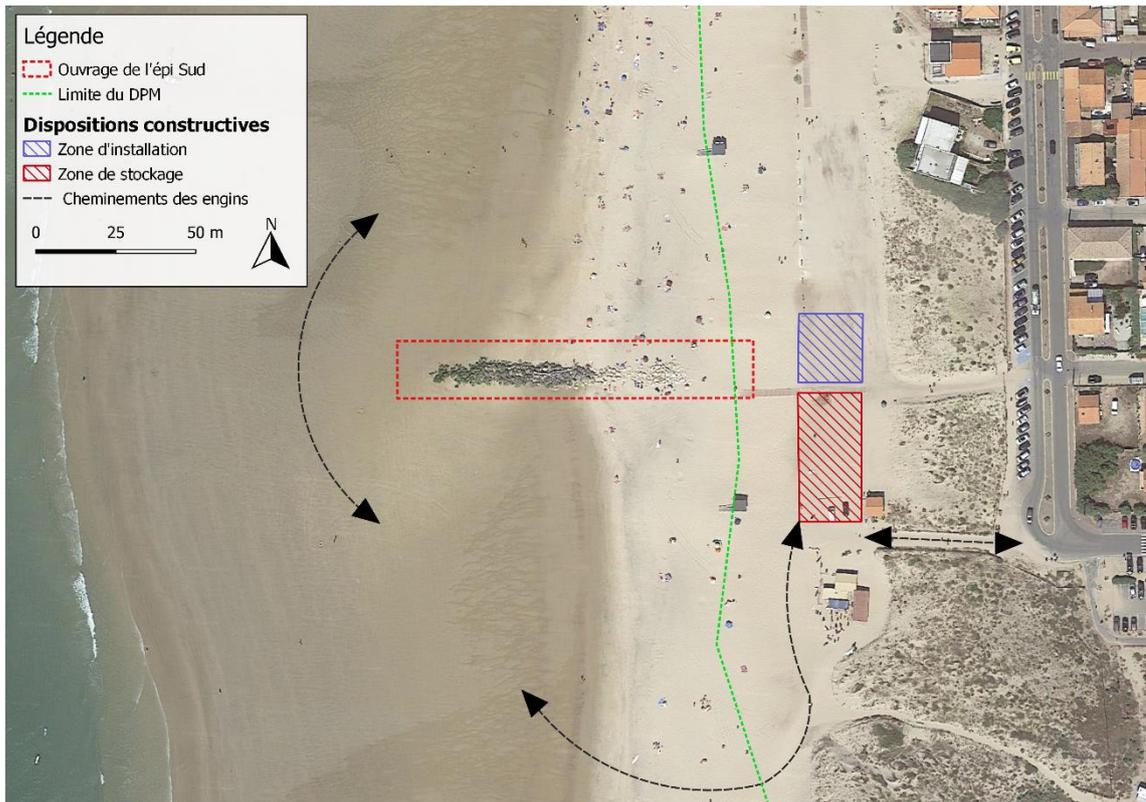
Localisation des installations de chantier dans le cadre des travaux d'allongement de l'épi Sud (Fond de plan : Google Satellite, 2021).
